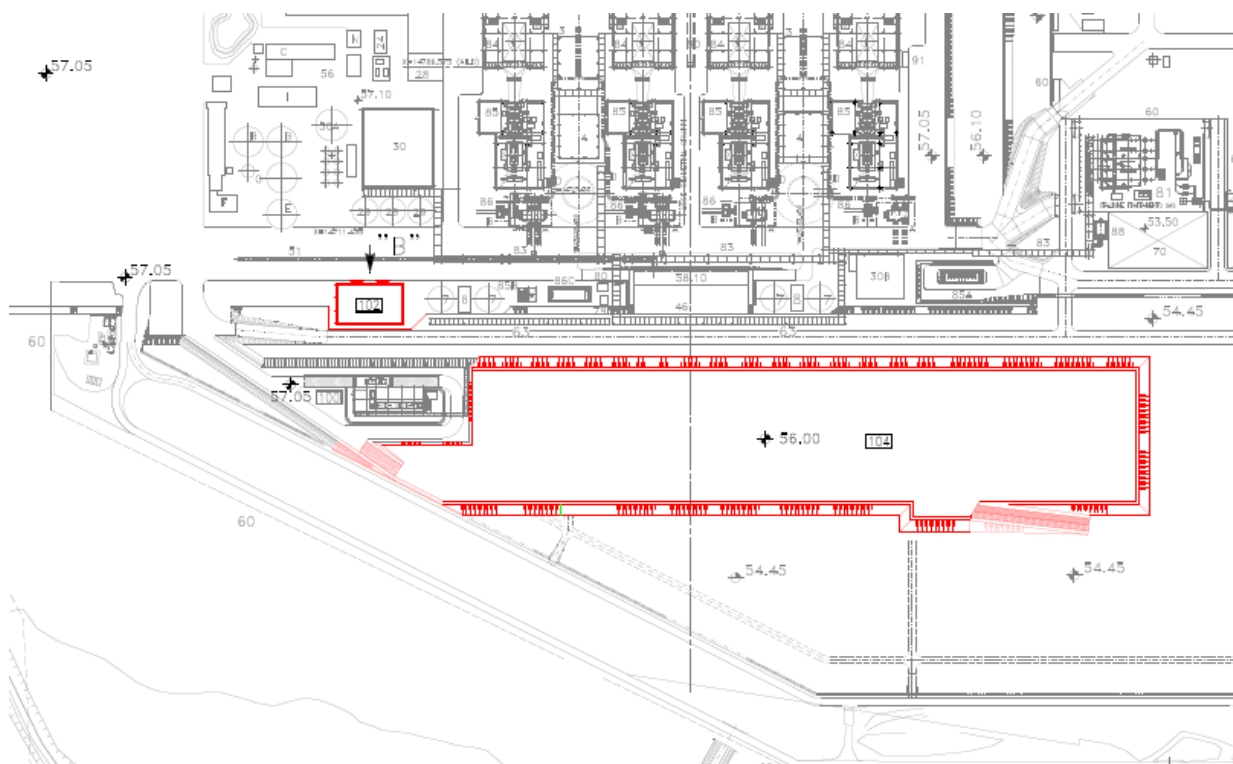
Stralcio planimetria fase "early works" sistemazione area ex serbatoi olio combustibile
